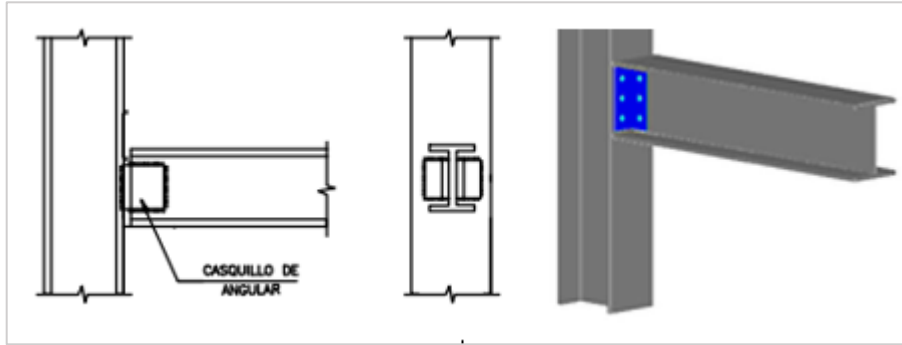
Unión viga, columna. Fuente: (Arquitectura en Acero)
